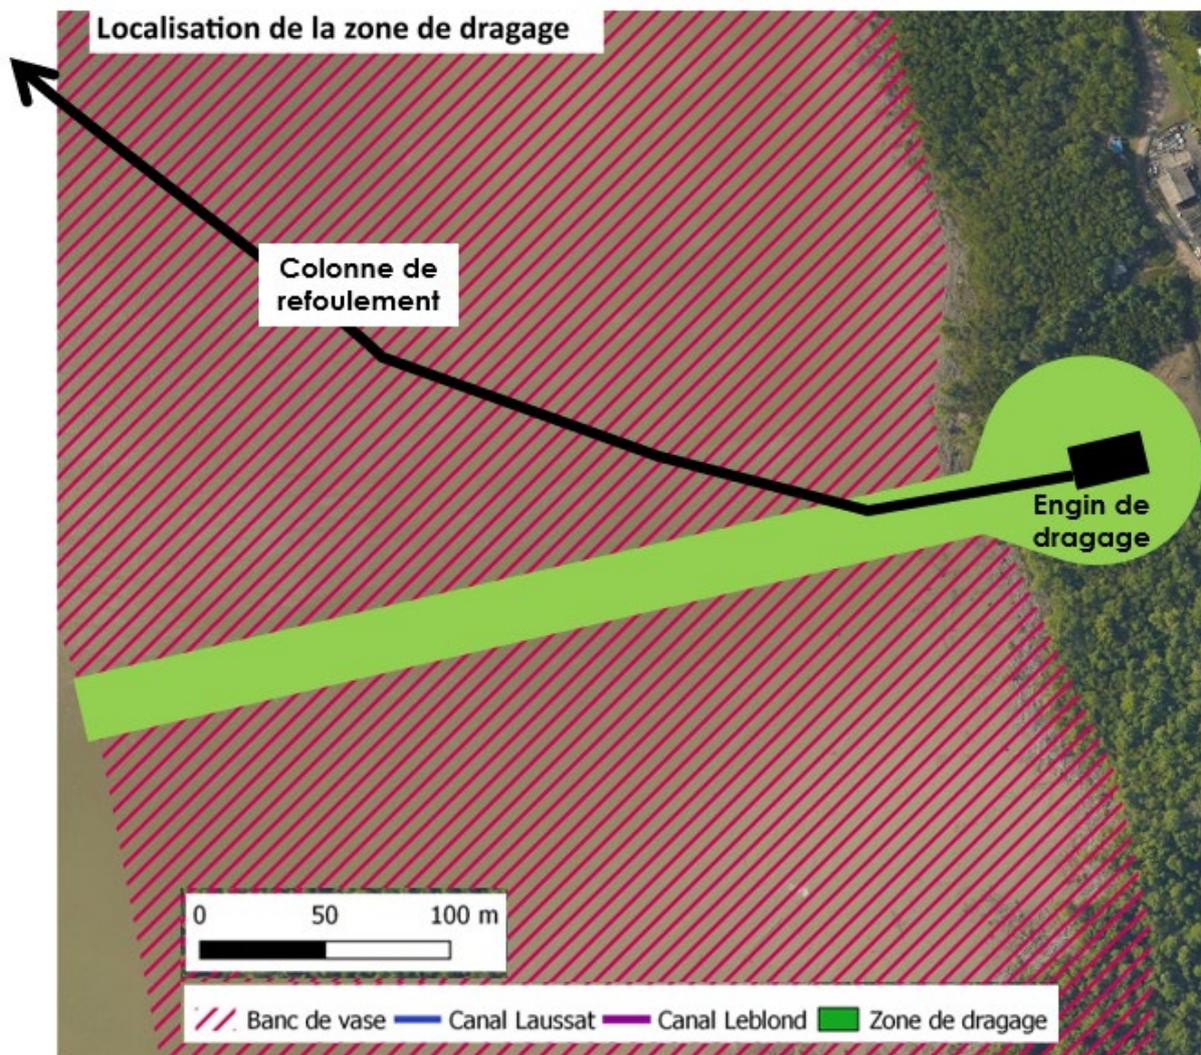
Colonne de refoulement pour le dragage du secteur 1.
